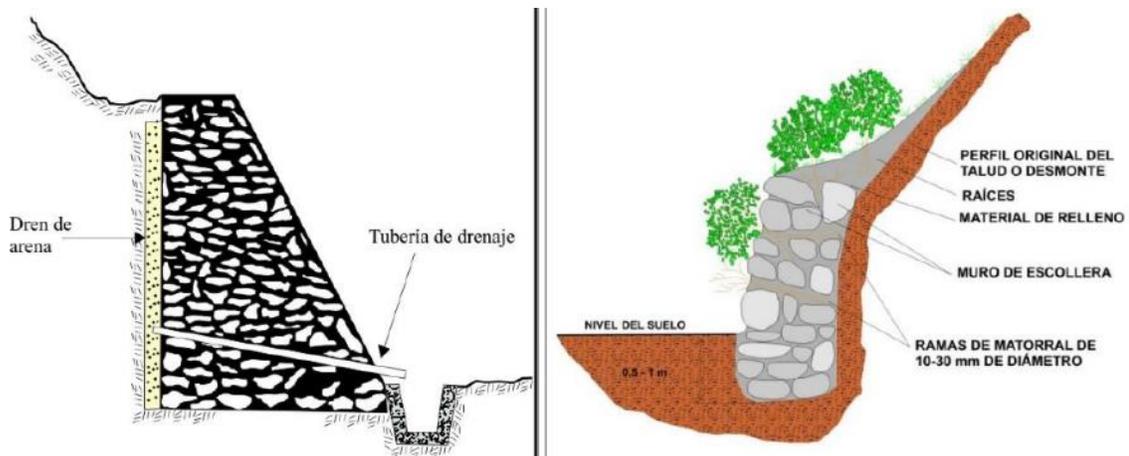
A) Muros de gravedad de piedra seca. B) Muros de gravedad de piedra argamasada. Tomado de Ingemmet (2000).
